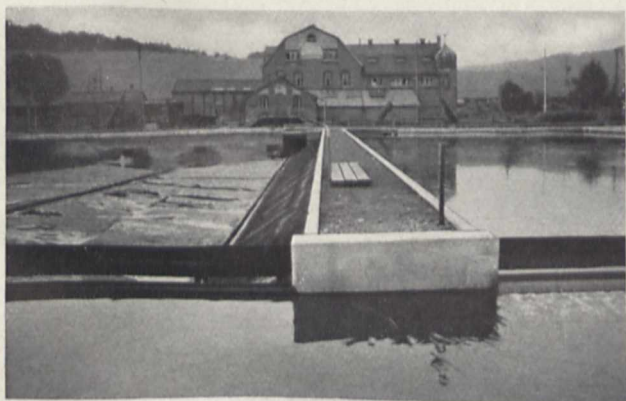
Absetzbecken mit leicht befestigter Sohle ohne Ausräumungsmaschinen
